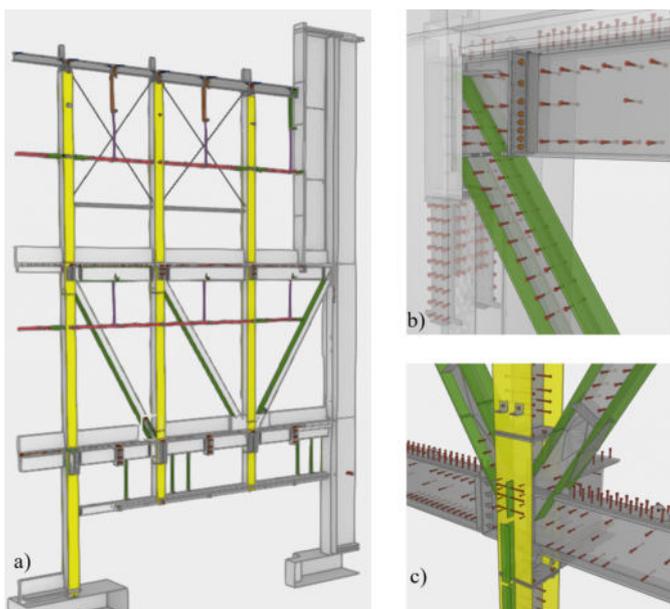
Gesamtansicht des Abfangfachwerks (a), Auflagerdetail Abfangfachwerk mit Einbauteil (b) und 3D-Modell des zentralen Anschlussdetails am Abfangfachwerk (c)
